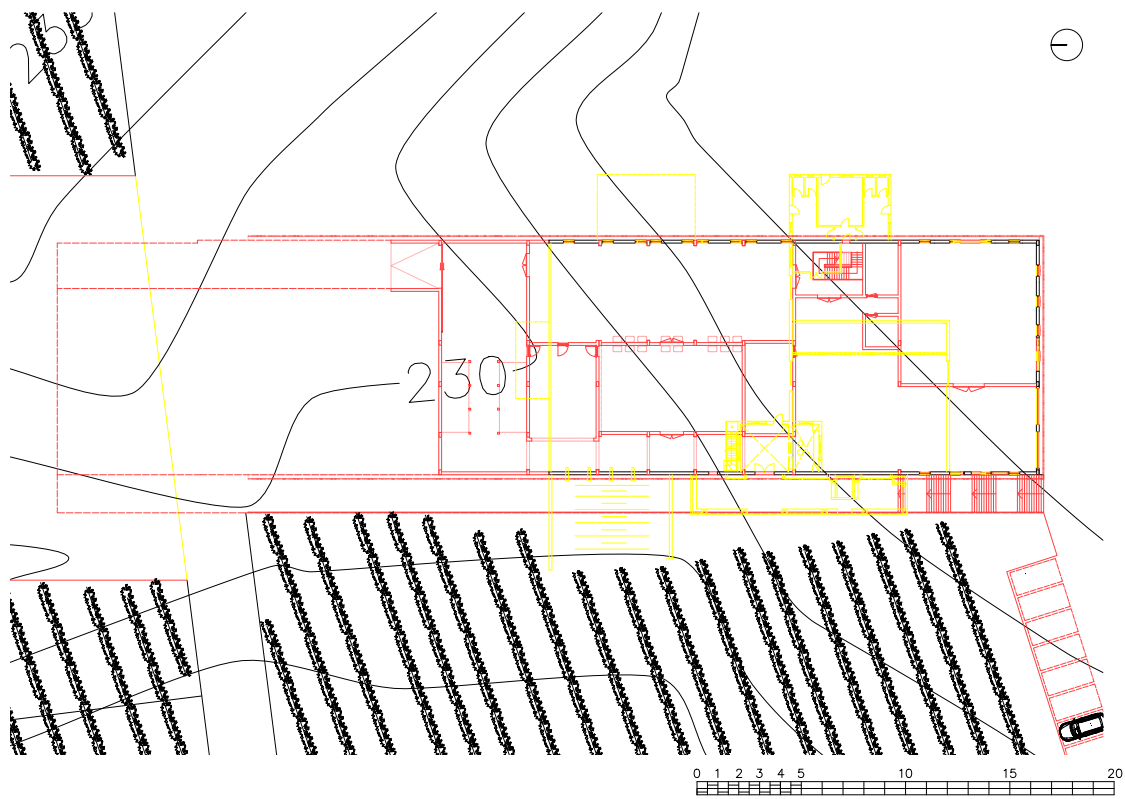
Planta Piso Térreo Vermelhos/Amarelos Esc.1:200
